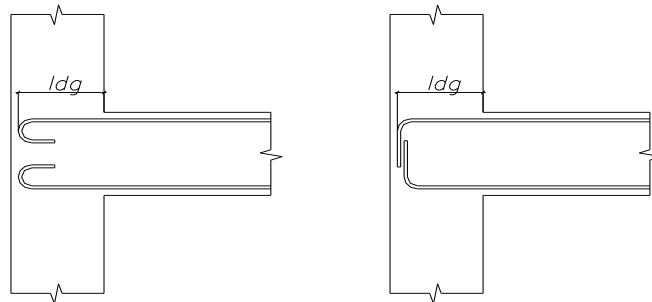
Longitud de anclaje con gancho estándar en tracción.
